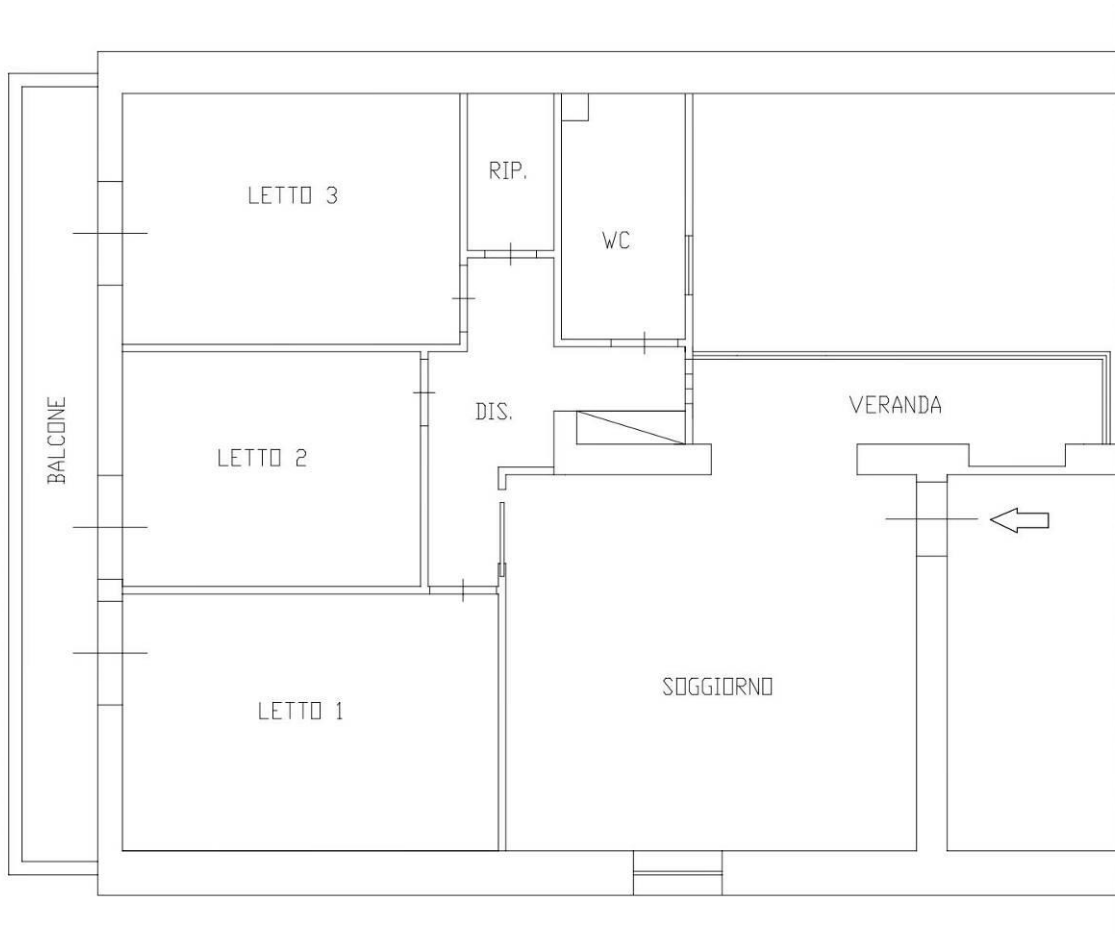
Planimetria dell'appartamento al piano secondo oggetto di pignoramento- interno 4
